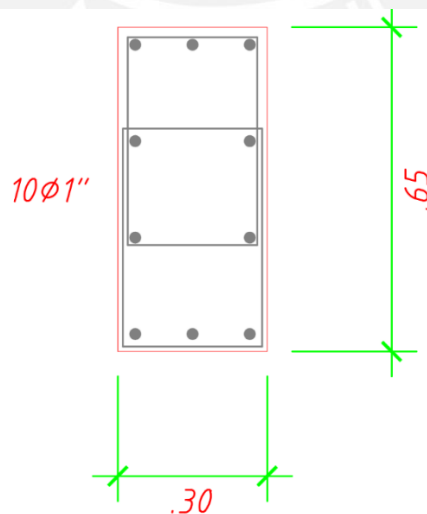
Refuerzo longitudinal propuesto en la columna C-01. Primer piso.
